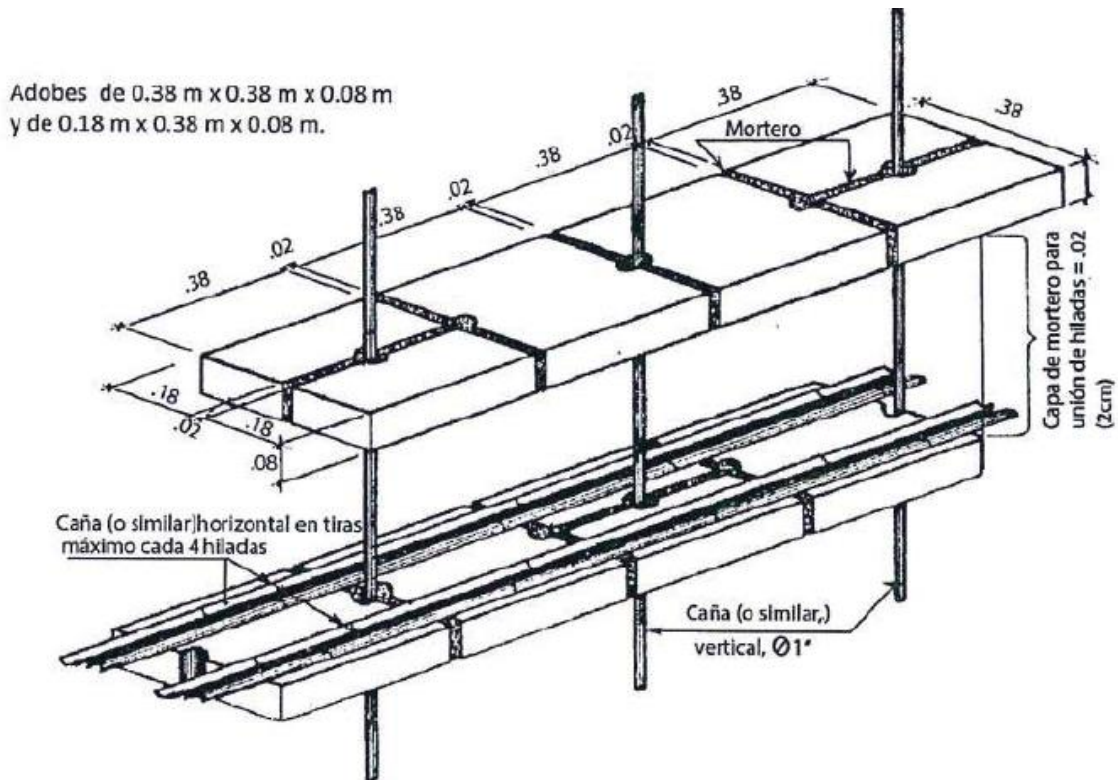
Esquema de refuerzos horizontal y vertical con caña o similar como máximos a cada 4 hiladas.
